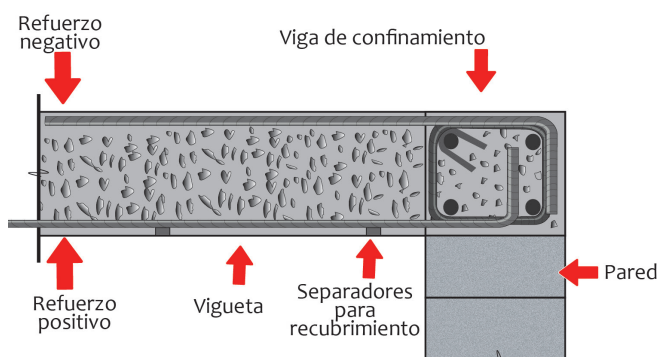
Refuerzo positivo y negativo en viguetas o nervios de la losa.
